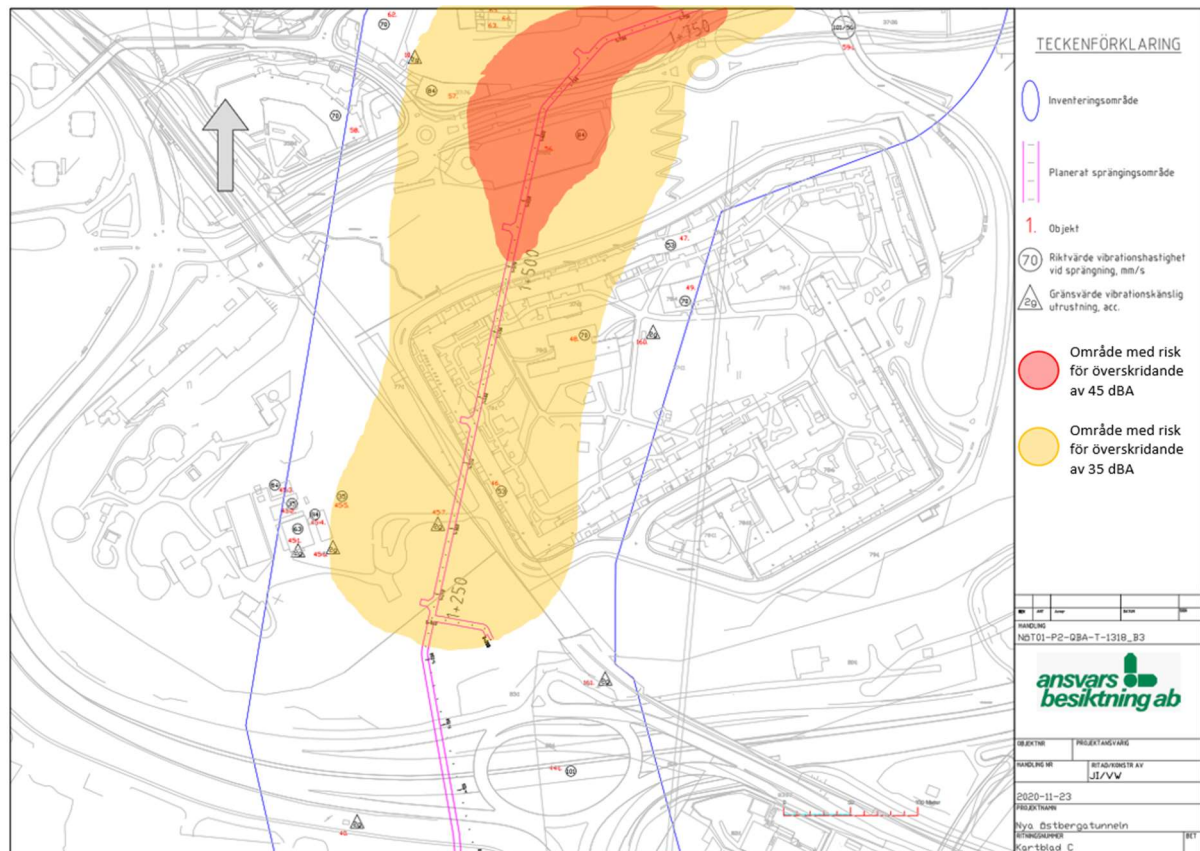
Tunnelsträckning och inventeringsområde med vibrationsrestriktioner
